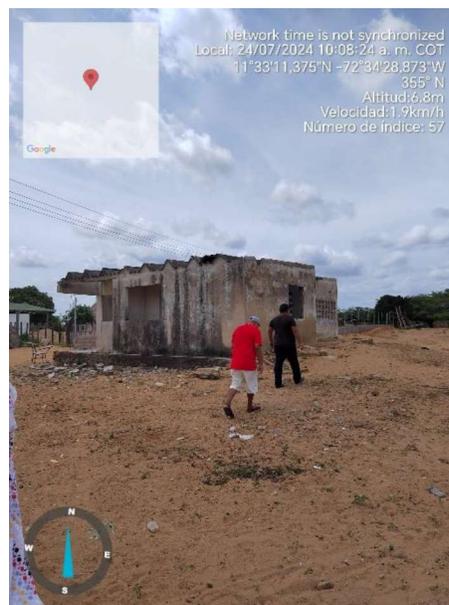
Fachada frontal del Puesto de Salud Curichi
